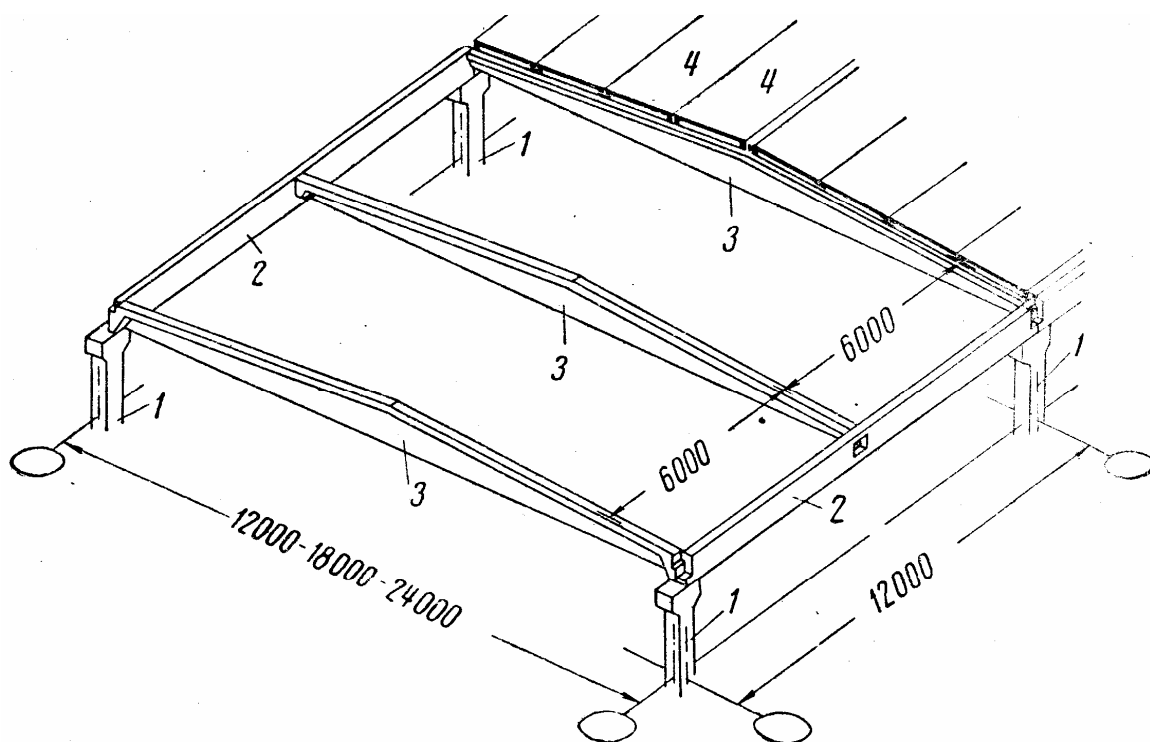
Схема расположения несущих элементов покрытия здания с подстропильными конструкциями
